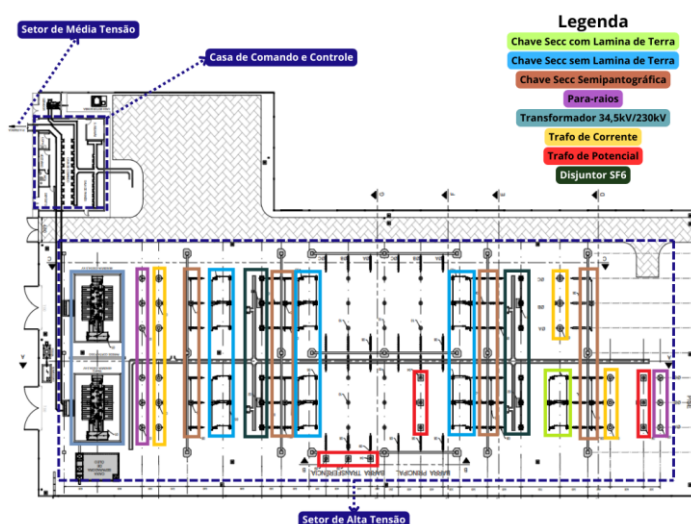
Planta da SE elevadora 34.5kV/138kV
